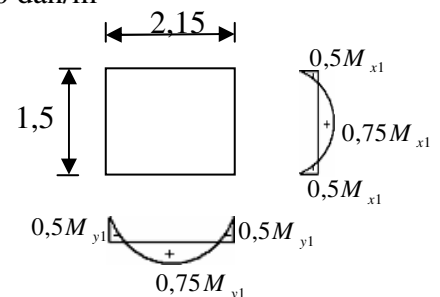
b.1.: dimensions de panneau 114
